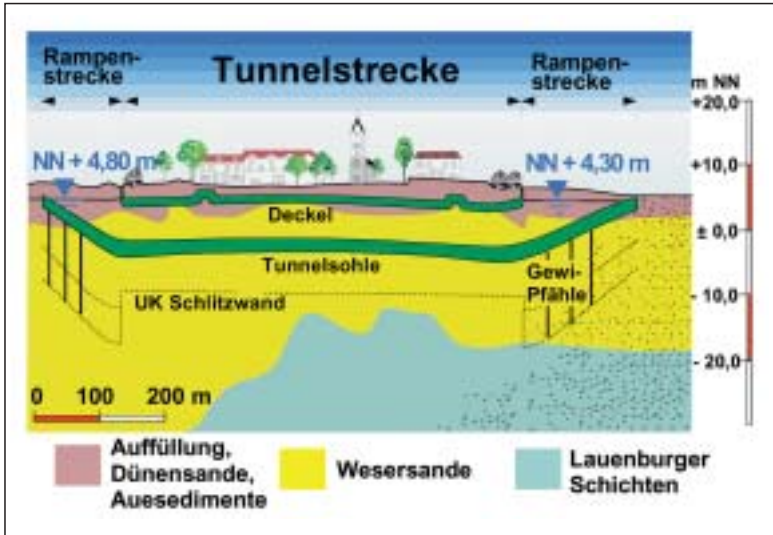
Untergrundverhältnisse im Bereich der Tunnelstrecke
